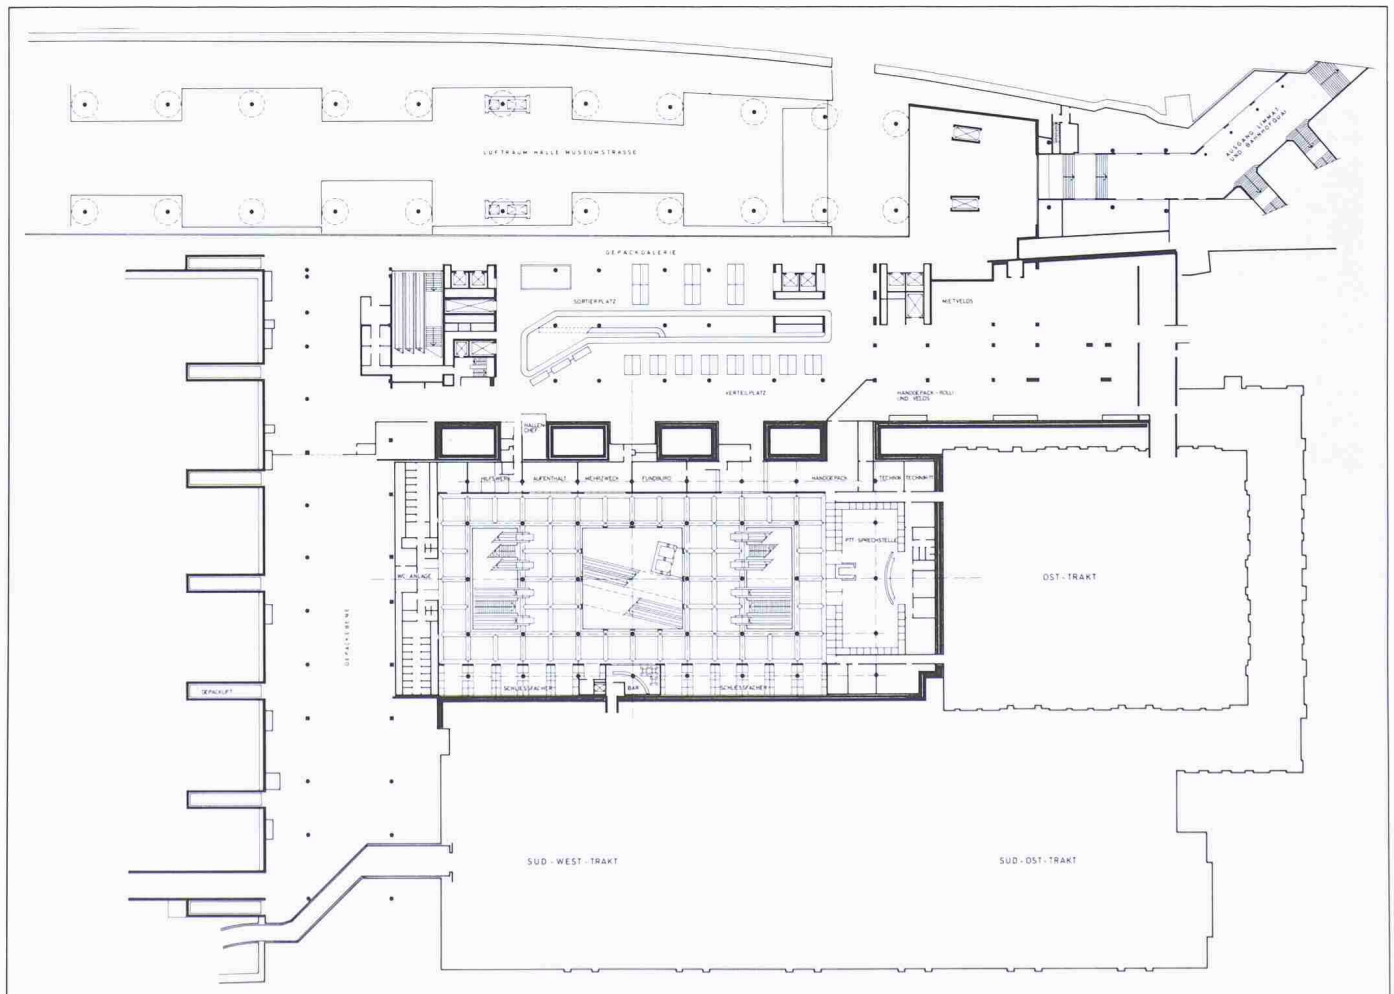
Grundriss Dienstleistungsebene (minus 1)
